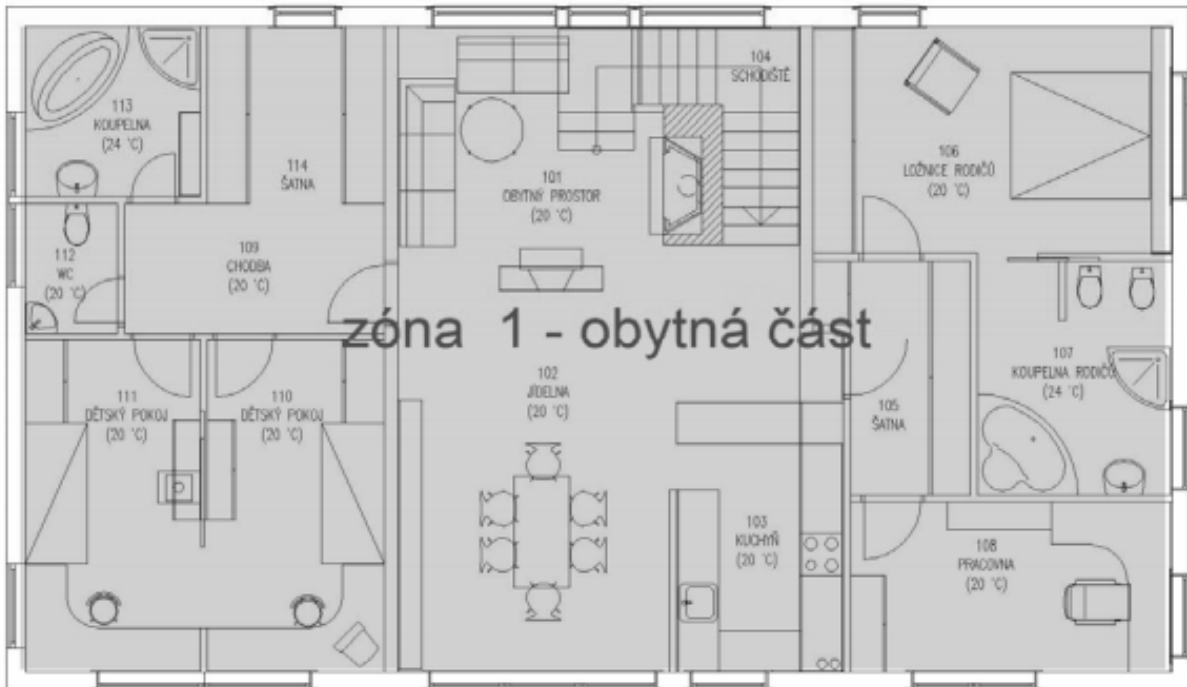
Haus Nr. 1006 Einfamilienhaus mit Solarkollektor 1Stock, Grundriss [19i]
